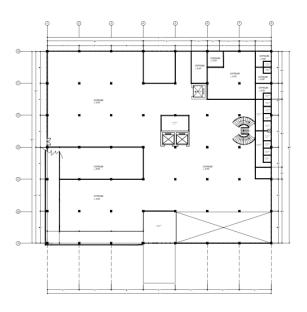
Denah Rencana Pintu Lantai 2 Sumber: dokumen pribadi
